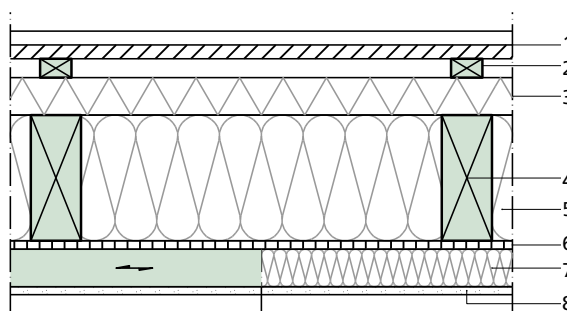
Außenwandquerschnitt in Holztafelbauart GK 0 mit Beplankung und Installationsebene (von außen nach innen):
